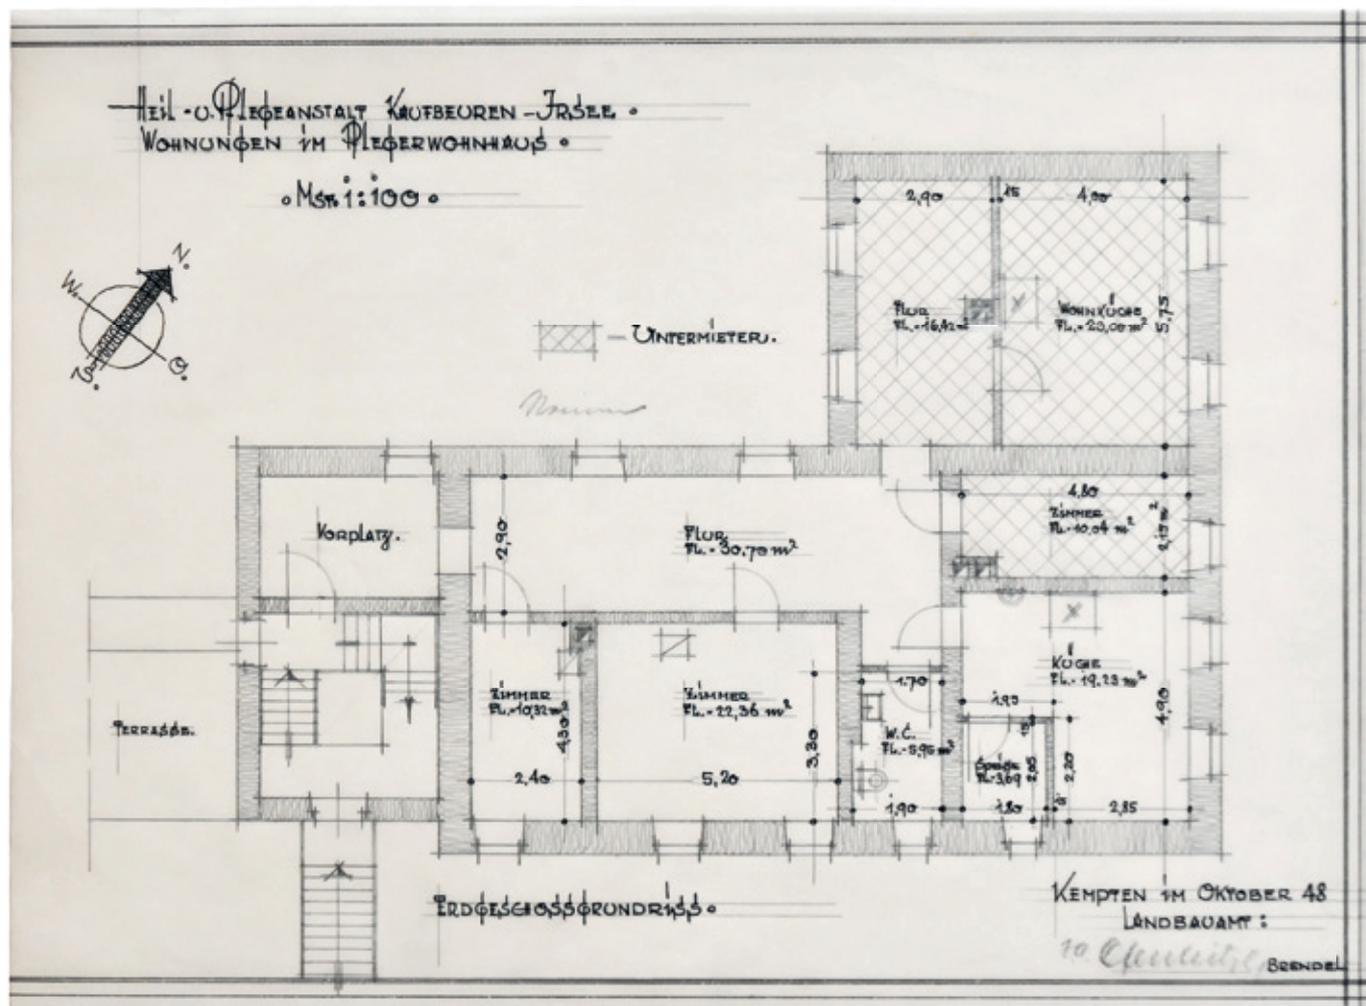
Plan von 1948. Grundriss Ebene 1 mit Angabe der untervermieteten Zimmer.
